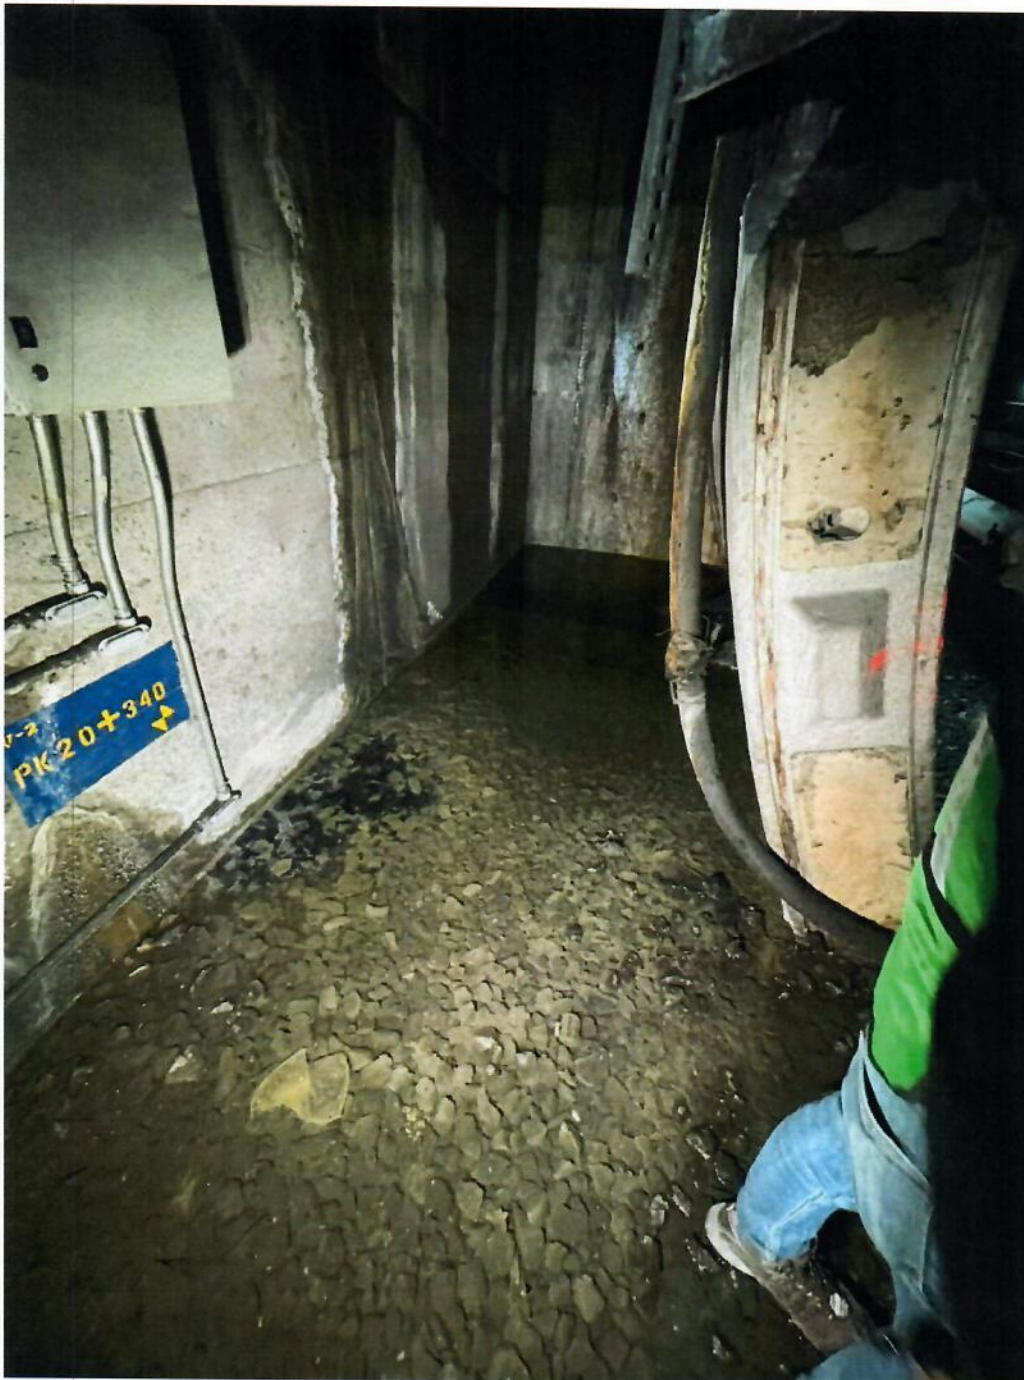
Falla estructural en las paredes del registro ubicado en el encadenamiento 20+400.
